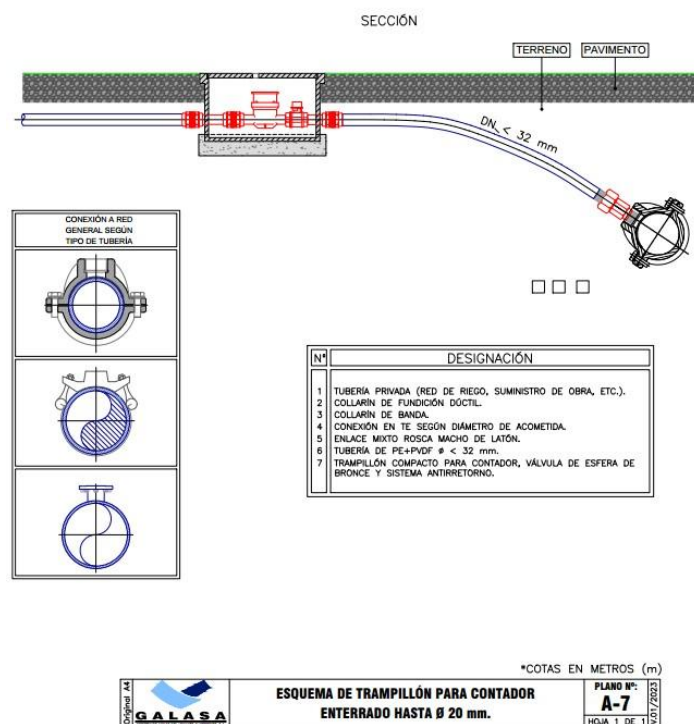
Detalle Constructivo IV. Instalación de contadores enterrados en arqueta HDPE. Fuente: Galasa
